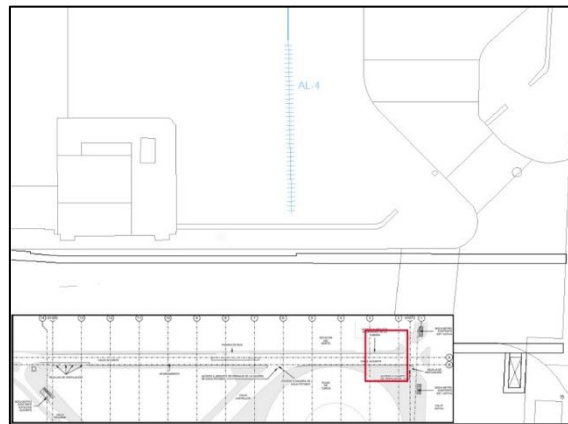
Plano de servicio afectado ALUMB-AL4-SA-CX-F7
